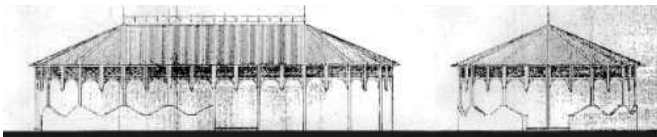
Antigo Pavilhão Atlântico - Praia de Iracema
